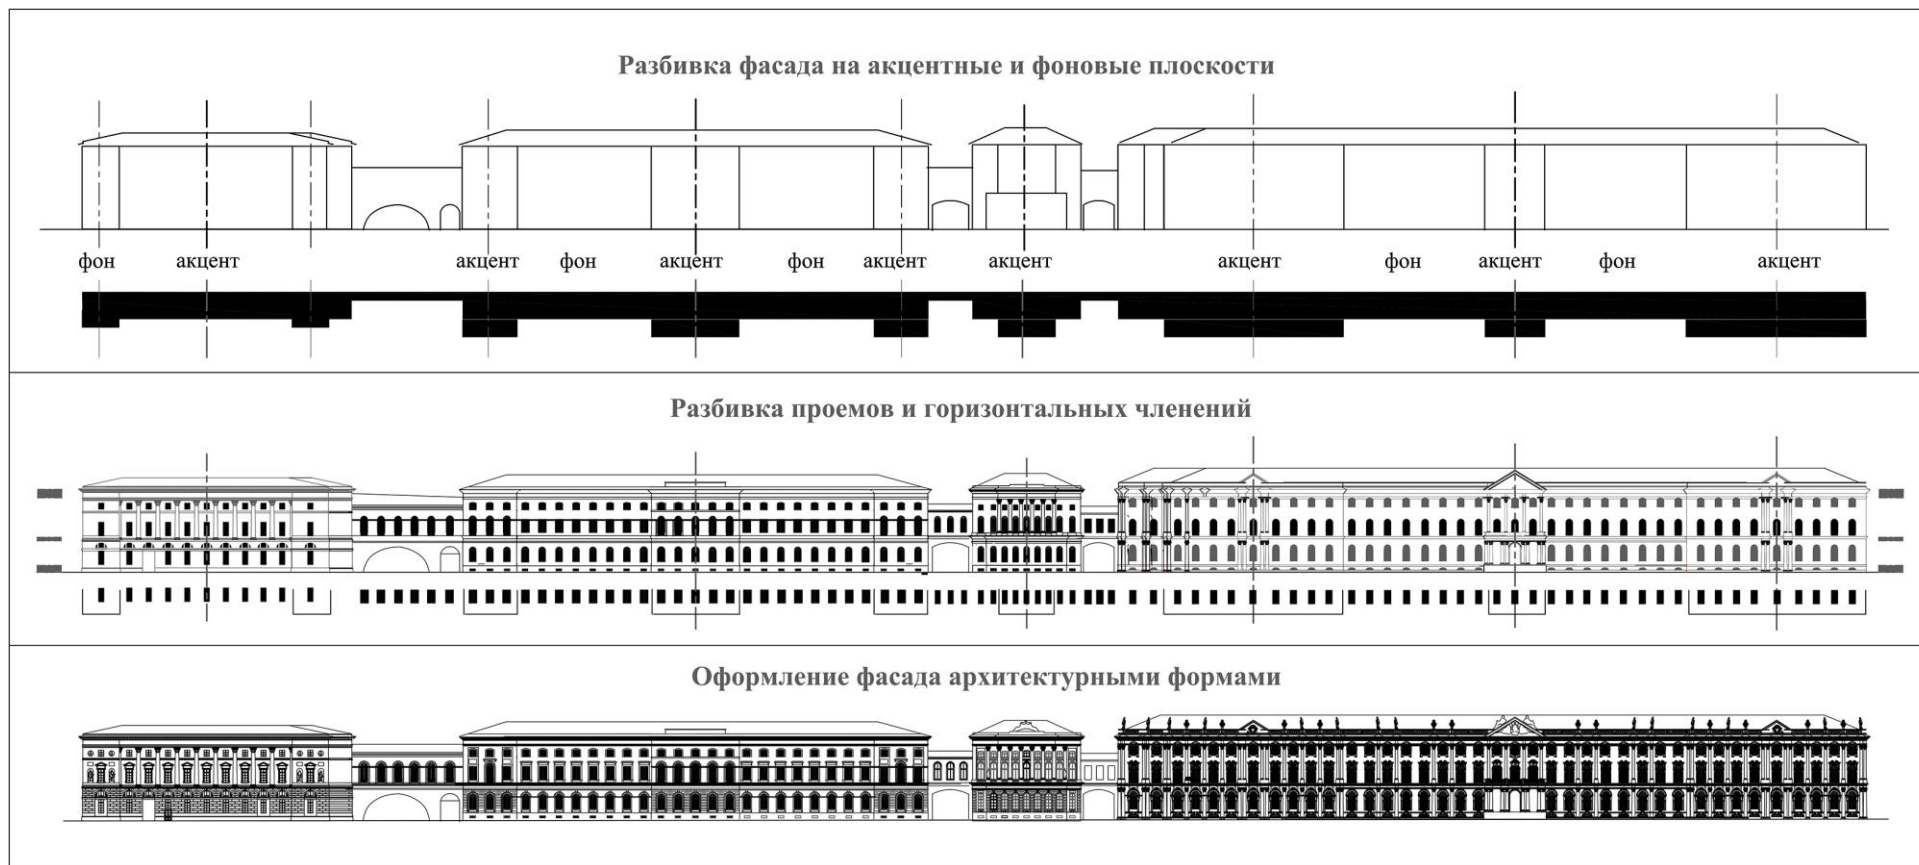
Композиционный анализ фасадов ансамбля Зимнего дворца и зданий Эрмитажа на Дворцовой набережной, архитекторы Ф. Растрелли, Ж.-Б. Валлен-Деламот, Ю. М. Фельтен, Дж. Кваренги (строительство 1754-1787 гг.)
